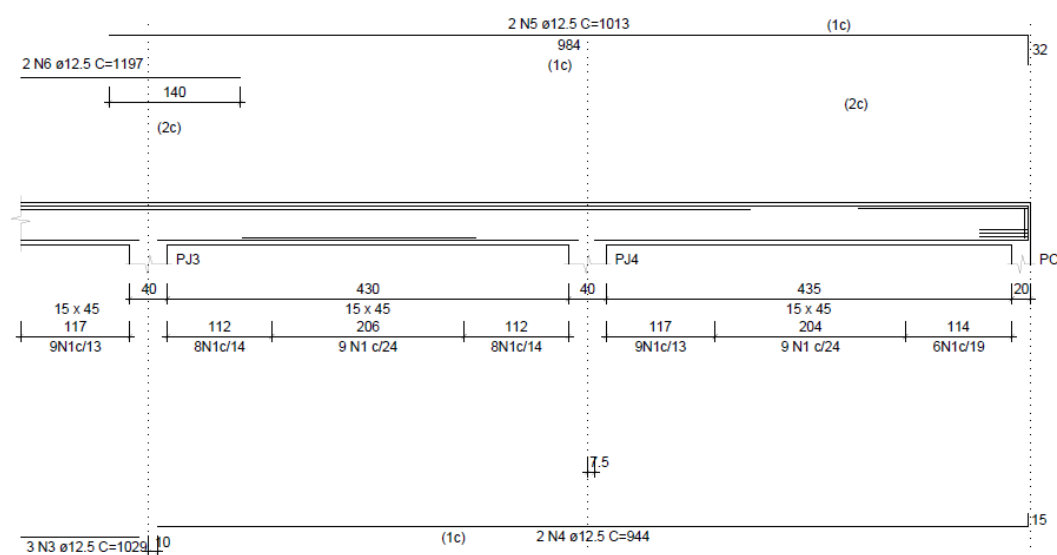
Detalhe de reforço das vigas da garagem (Seção B)
